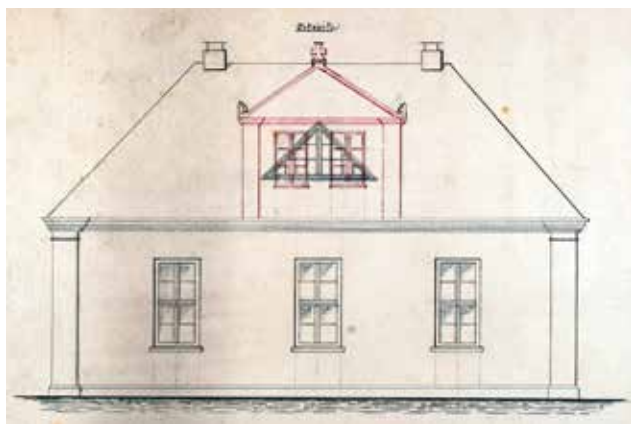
Aufriss der Ostseite des Hildesheimer Leichenhauses mit Einzeichnung des Einbaus einer Dachgaube, nach 1860. (StadtA HI Best. 950 Nr. 1970)
